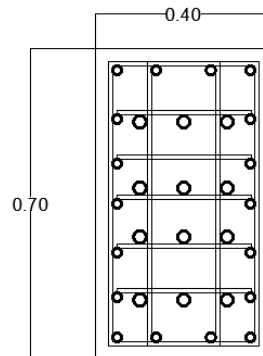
Detalle Acero Longitudinal, Transversal y Diagonal Viga de Acople A
